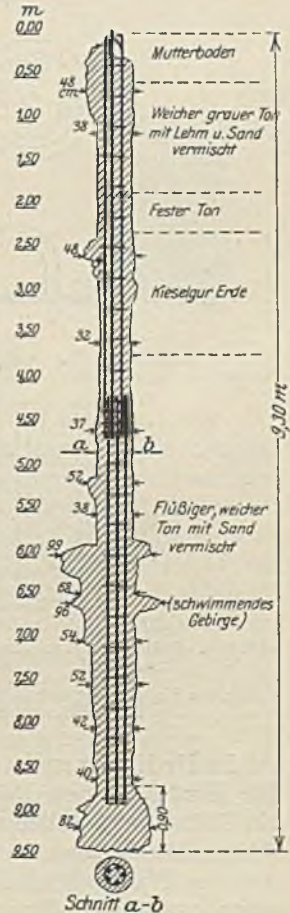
Ausgegrabener Preßbetonpfahl Bauart Wolfsholz.
